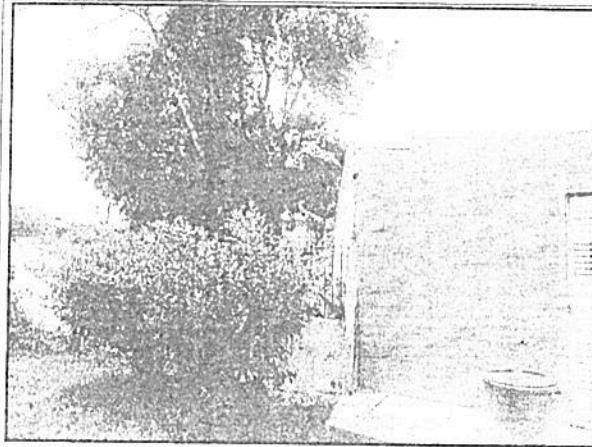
Vista frontal do muro entre os lotes 532 e 533.
